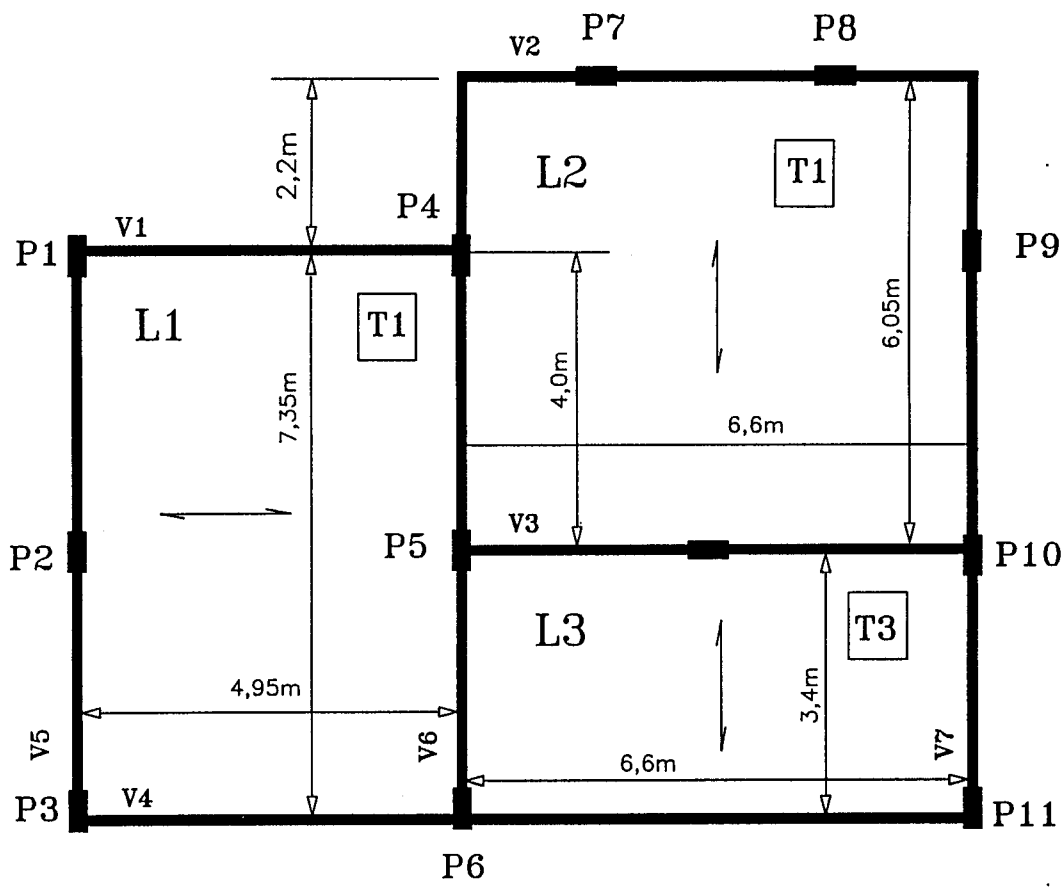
ESTRUTURA 2.1 - ESQUEMA - LAJE PRÉ-MOLDADA
